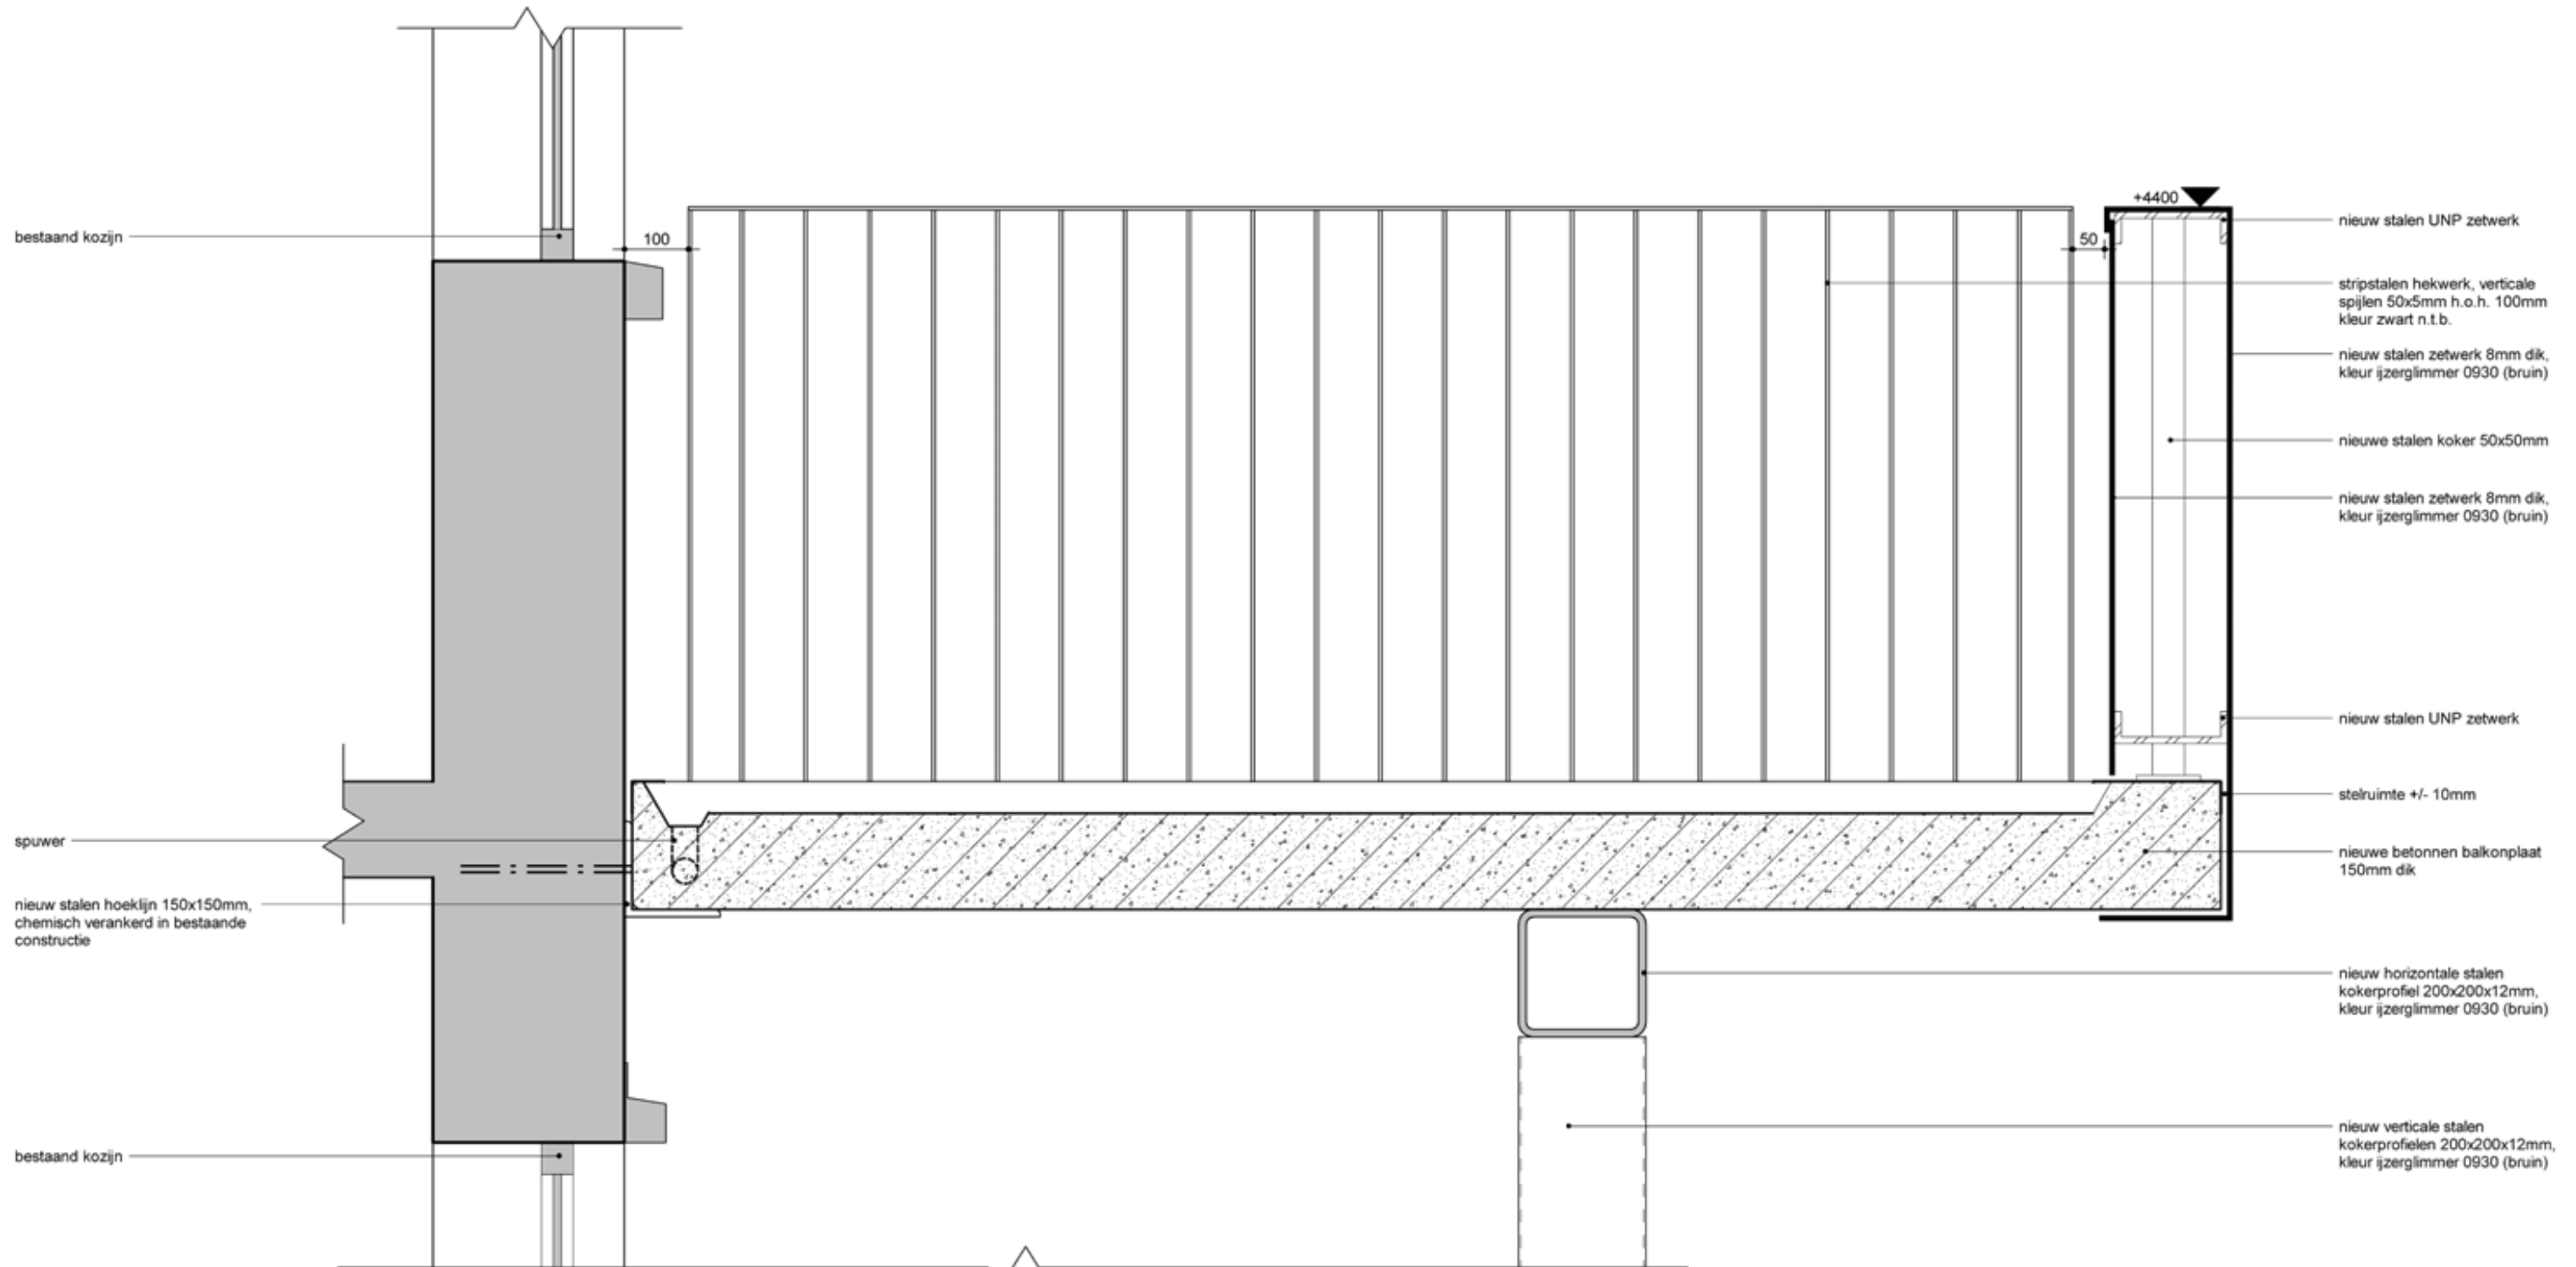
| toevoegen van nieuwe buitenruimte, balkon op pergolaconstructie | Schaal 1:10
